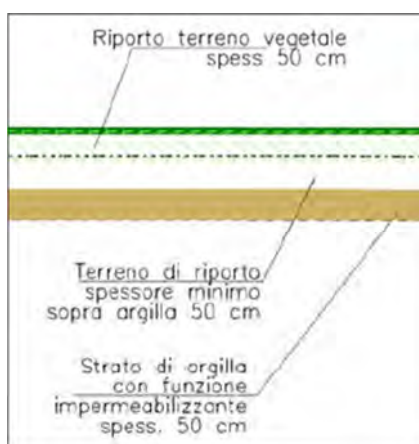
Sezione tipo di posa dello strato a permeabilità ridotta sotto il piano cassa (da “Relazione Generale” del progetto definitivo [1])
